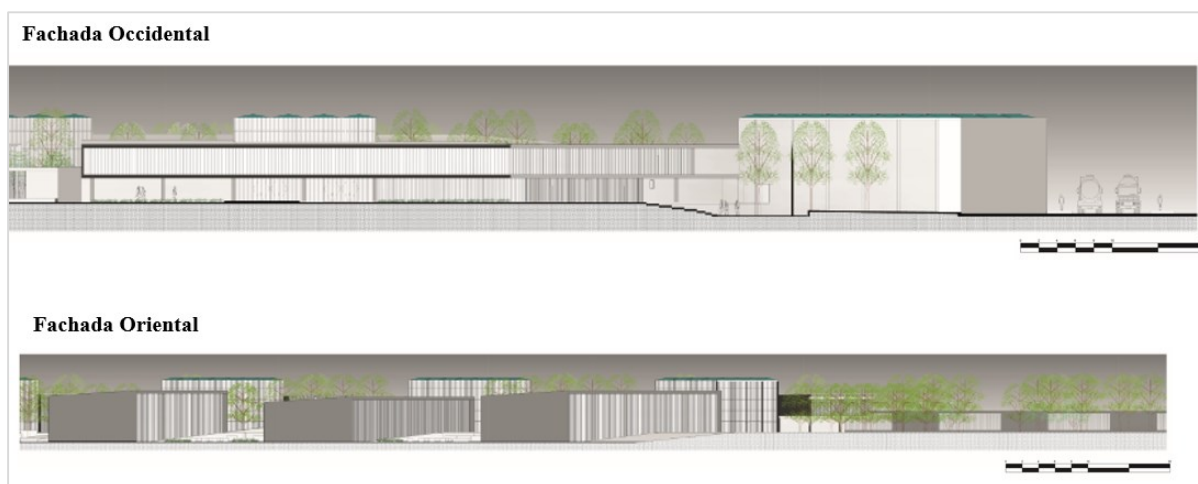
Fachadas Arquitectónicas Occidental y Oriental.
